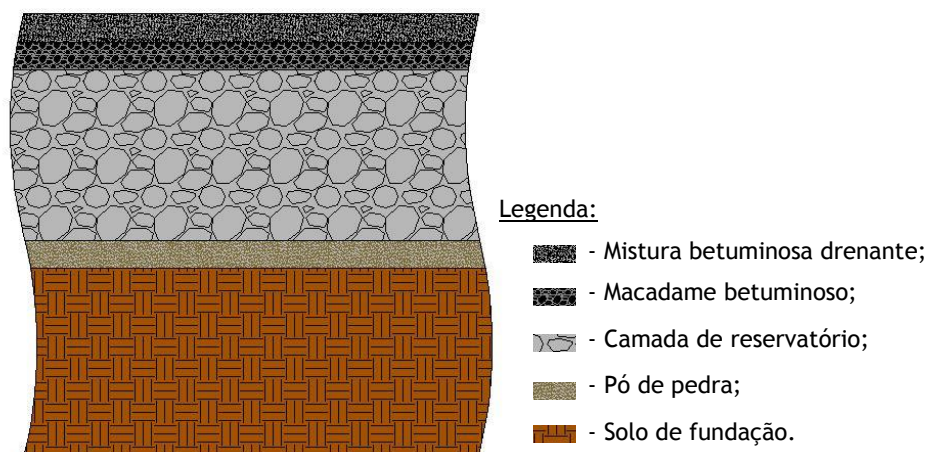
Estrutura tipo VIII (adaptado de Virgiliis, A., 2009)
